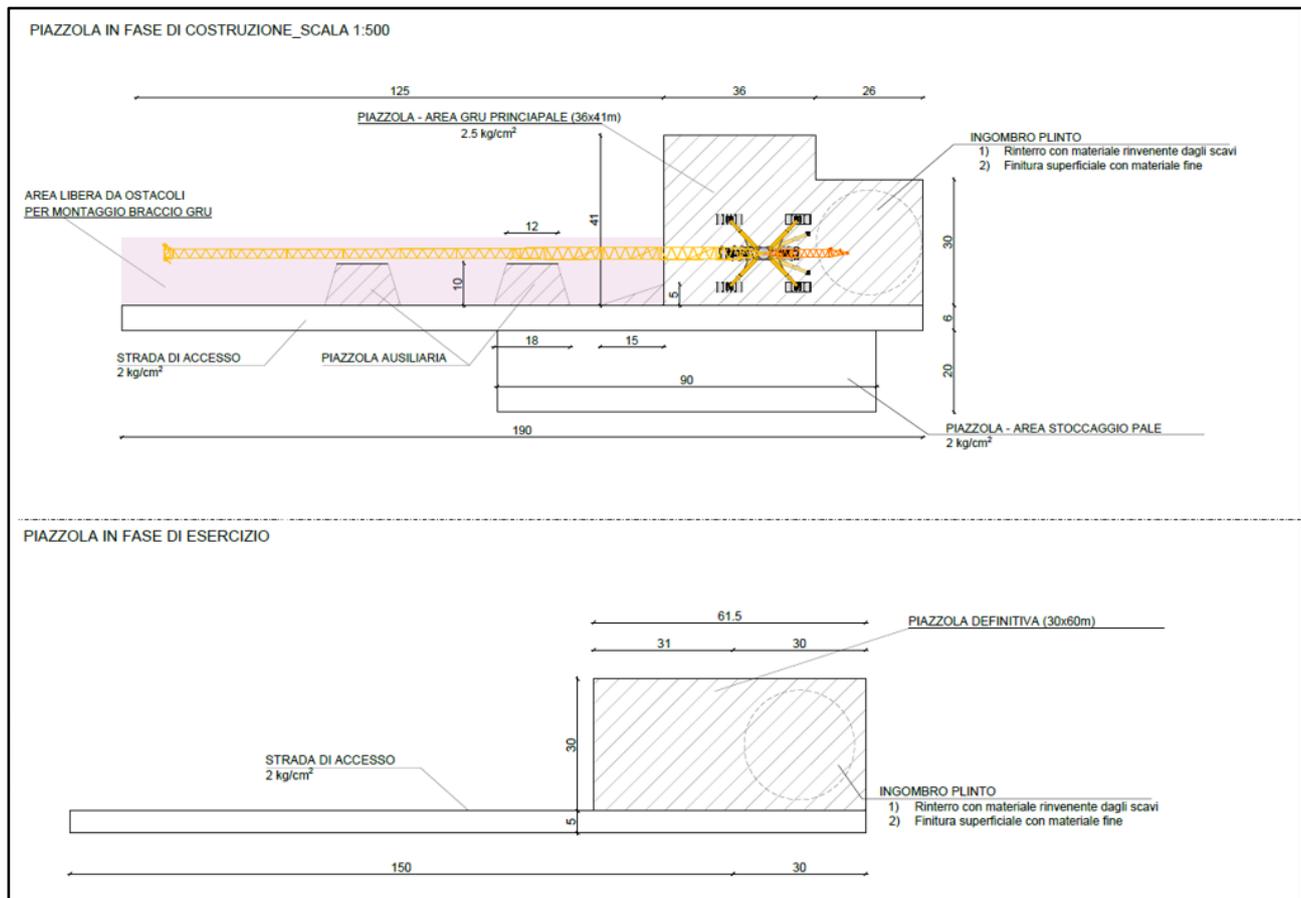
Planimetria piazzola tipo per la fase di installazione e fase di esercizio e manutenzione
